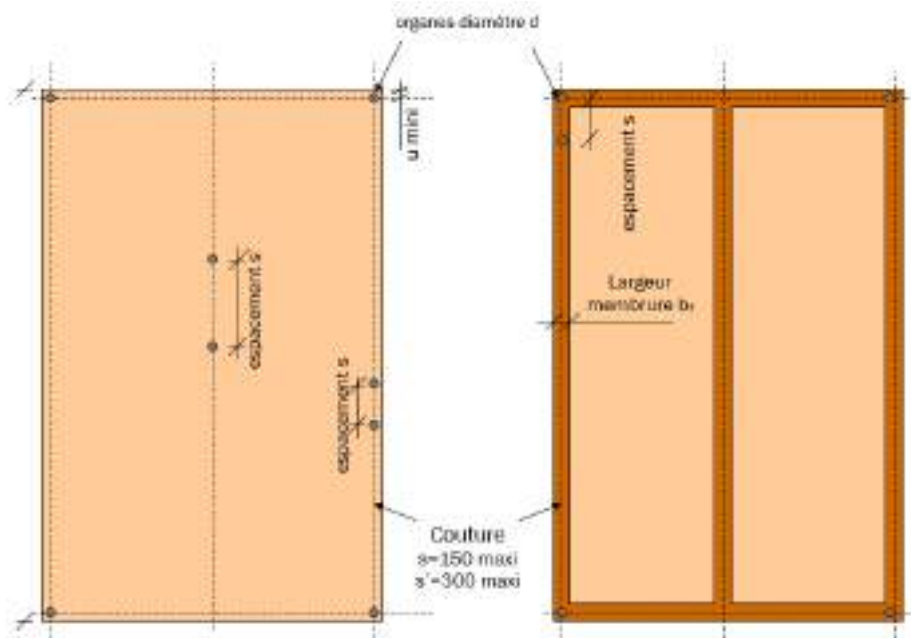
Fixations de couture d'un panneau de contreventement sur l'ossature
